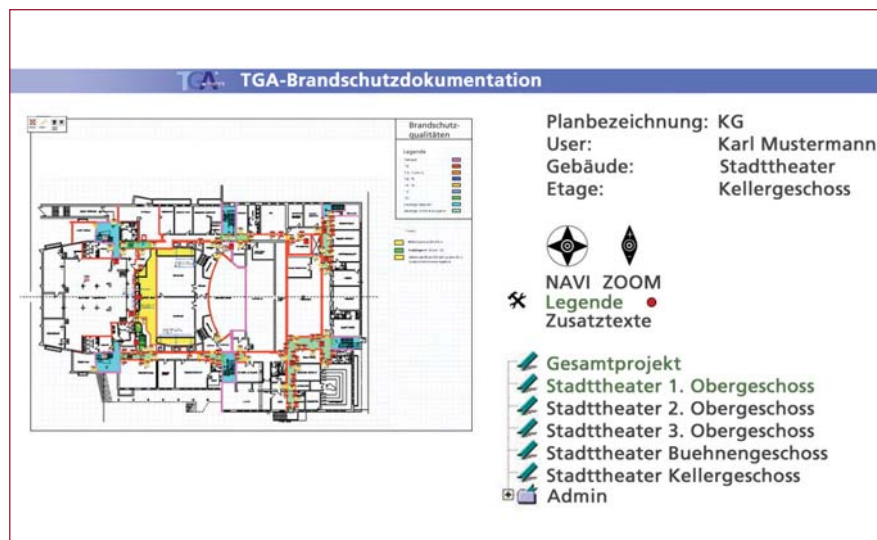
Beispielplan auf Grundlage eines unter CAD erstellten Brandschutzplanes mit Kennzeichnung der Mängelpunkte
